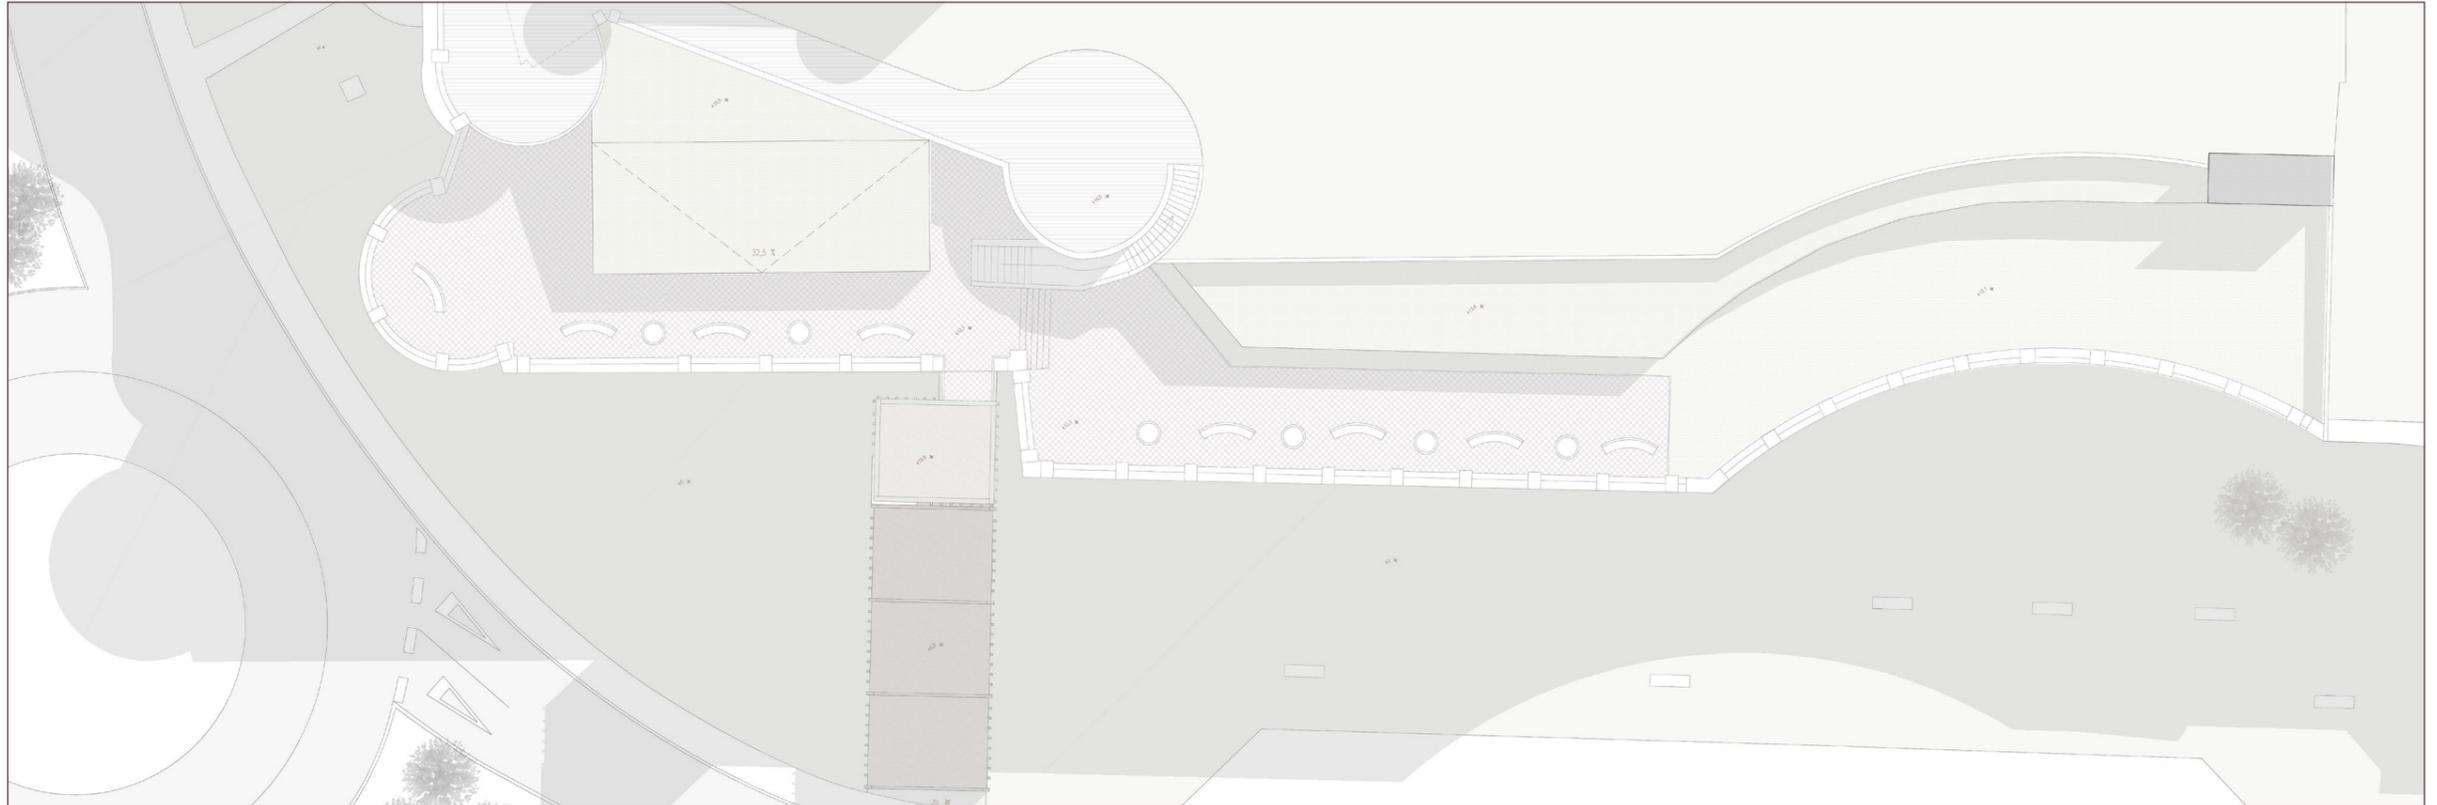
Planta de cubiertas de la galería suroeste, con las cubiertas de la ampliación y las terrazas-cubierta del espacio coworking.
